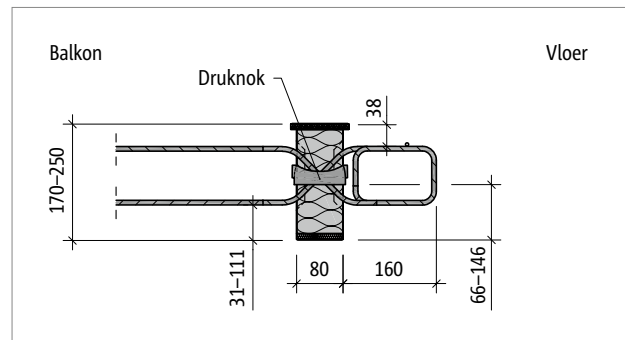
Schöck Isokorf® T type Q-E-V7: Zijaanzicht
